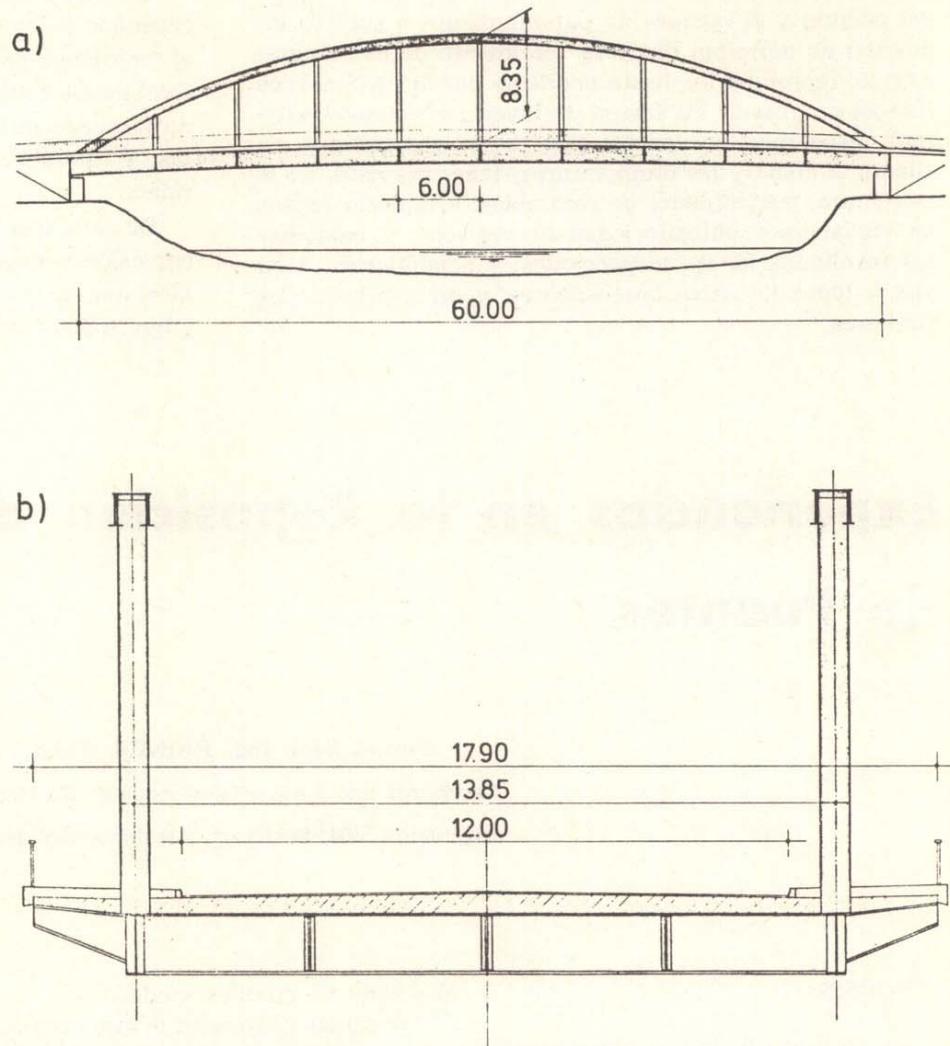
Puente Ulmenstraße. Conjunto: a) Vista. b) Sección. Según (3).
